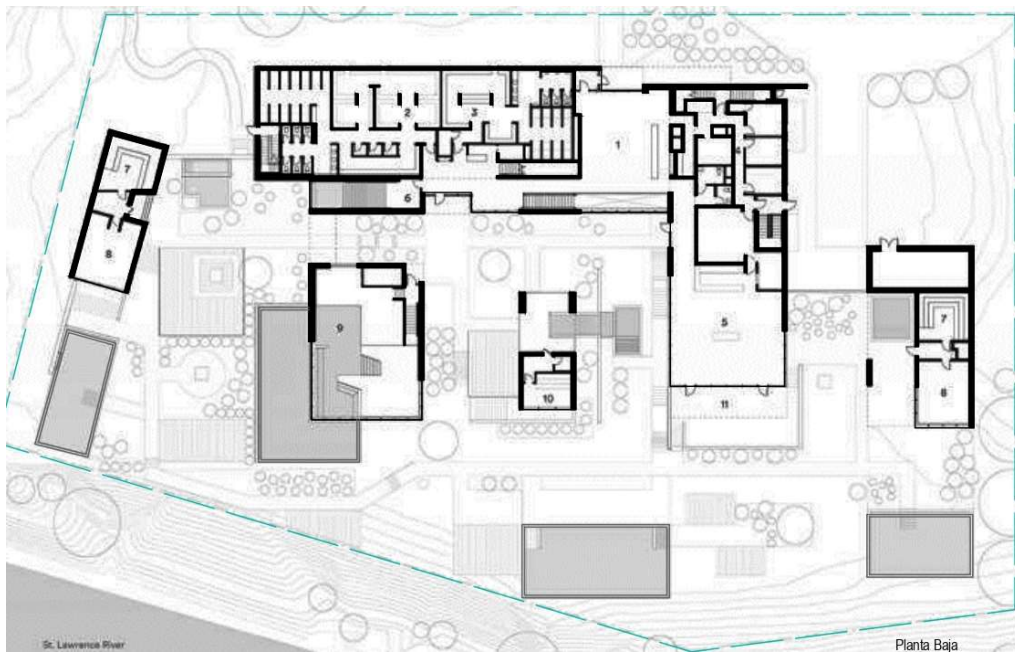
Análisis de precedente 1: planta baja. Elaboración propia.
